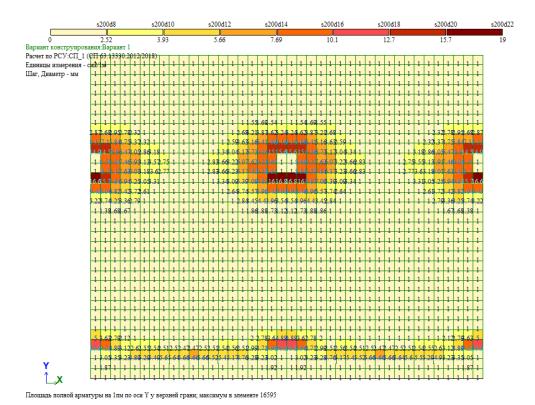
Требуемое верхнее армирование перекрытия по Y, до усиления
